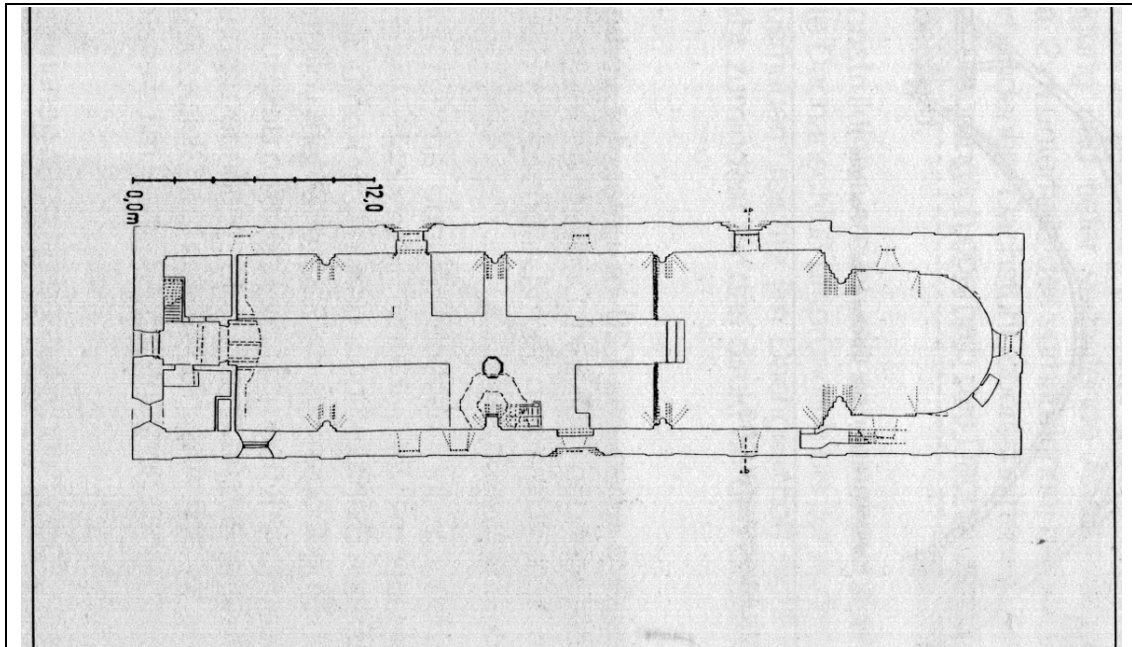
Grundriss der Kirche (Zeichnung aus: Haupt et al., 1990, S.108)
